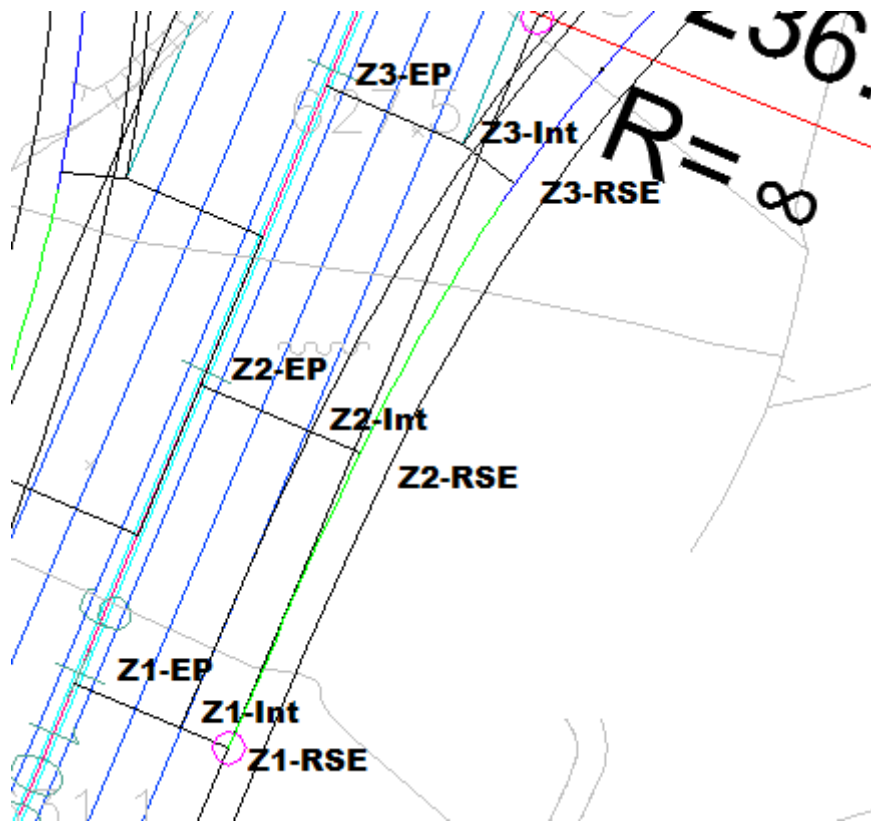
Pormenor dos Pontos de Estudo da Rasante do Ramo SE
